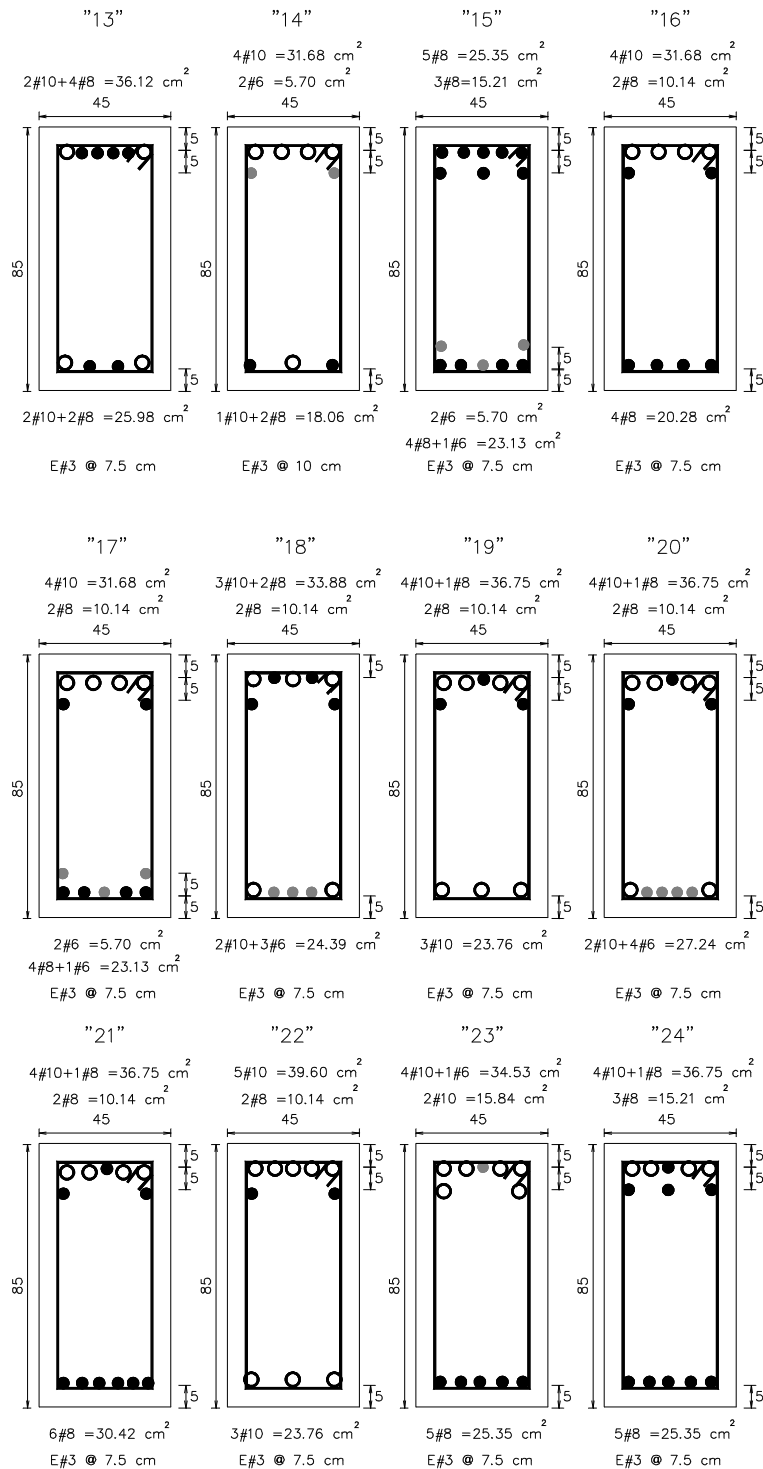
Tipos de armados propuestos para los extremos de las vigas del eje 2, estructuras de 17 niveles diseñadas en zona III (RDF-93 y RDF-04)
